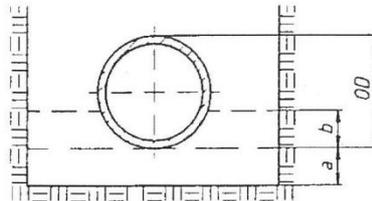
Bettung Typ 1 (nach DIN EN 1610, Bild 3)
